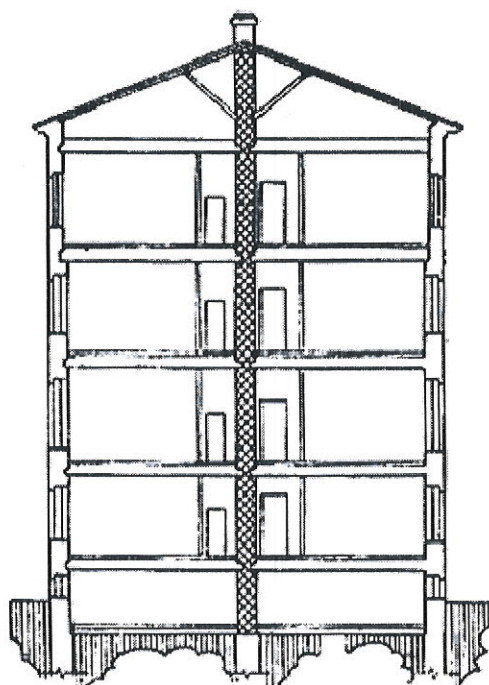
Проектное решение по перекладке участка средней продольной стены, показанного на рис. 1 б с сохранением существующих перекрытий
